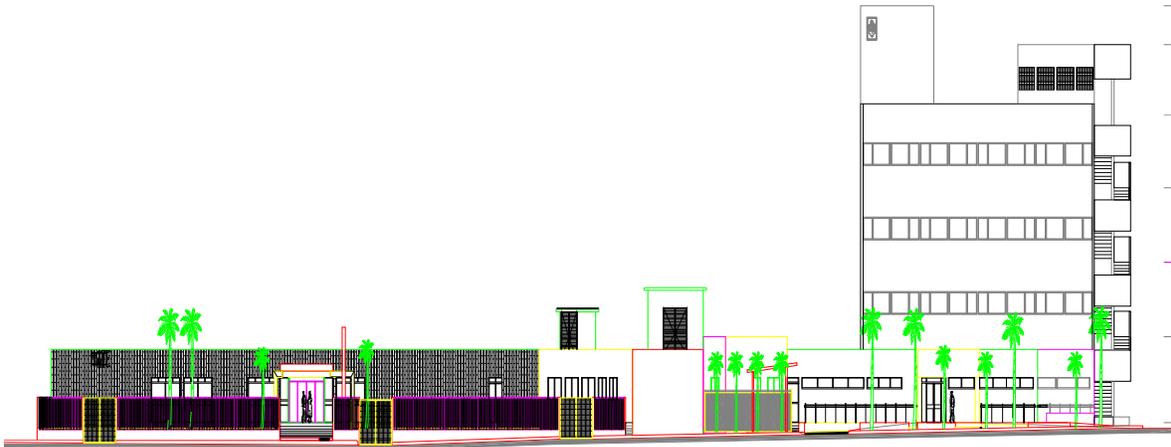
FACHADA PRINCIPAL, CALLE SAYULA
